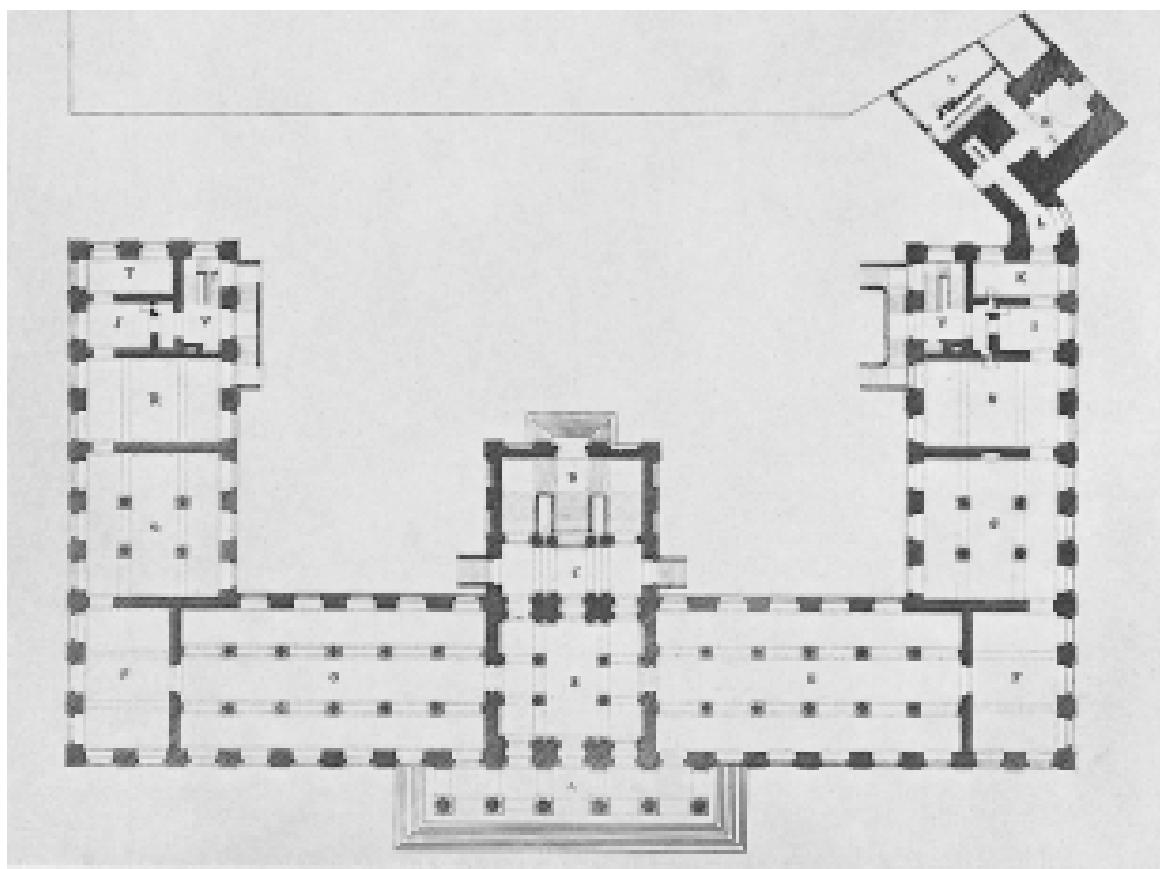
Grundriss Museum Fridericianum, Erdgeschoss,
